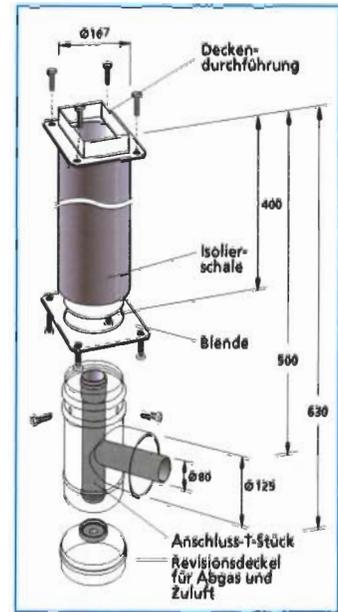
Deckendurchführung der Kellerdecke mit Anschluss T-Stück im Aufstellraum.
